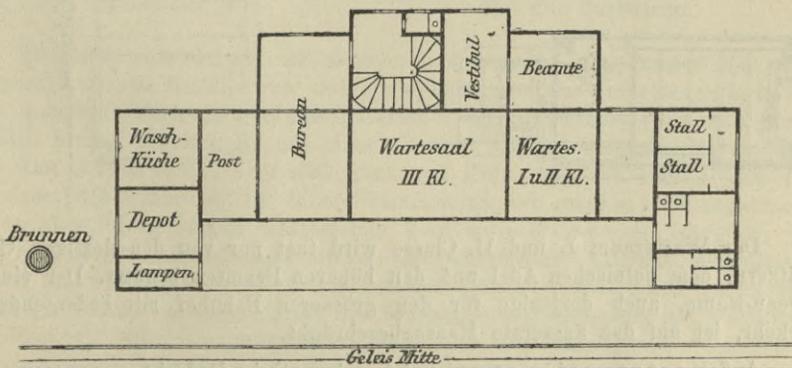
Aufnahmsgebäude II. Classe. Grundriss.
